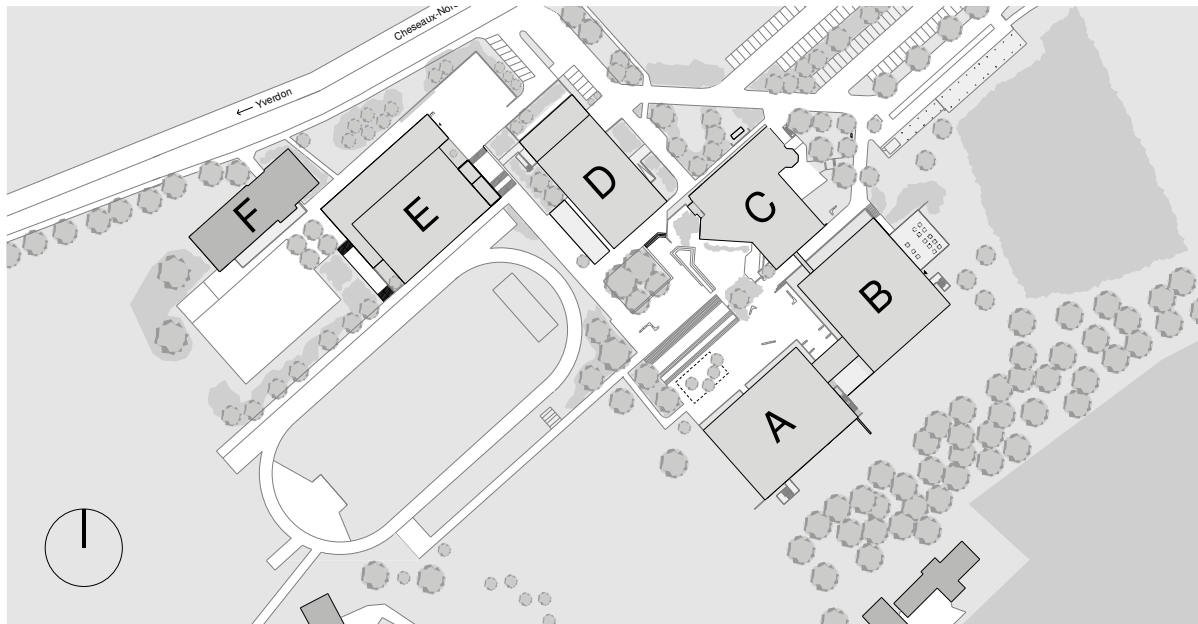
Plan de situation - Gymnase d'Yverdon-les-Bains
